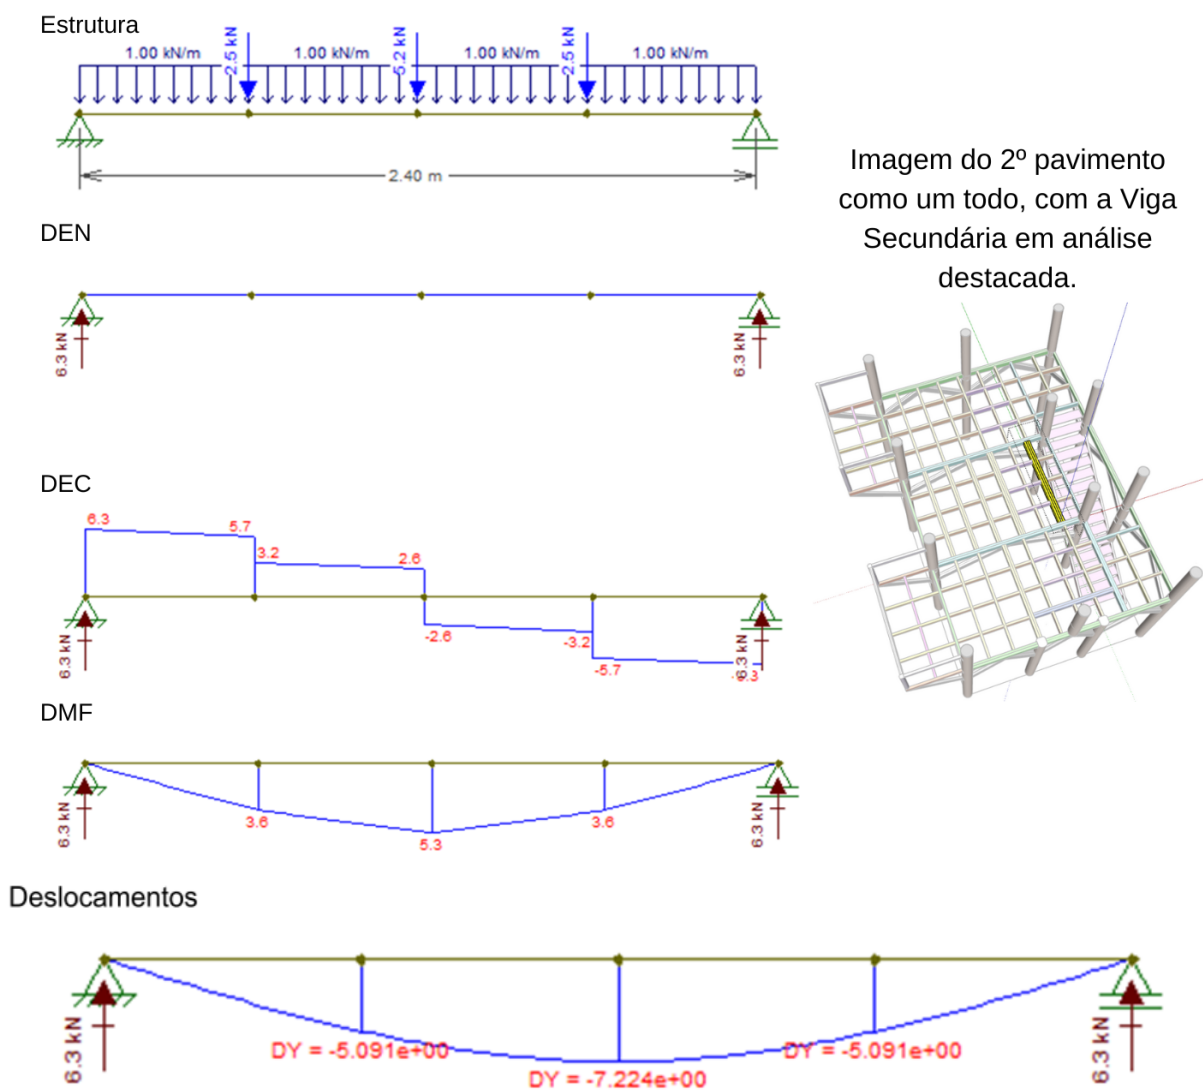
Esquema e análises estruturais de uma das vigas secundárias
